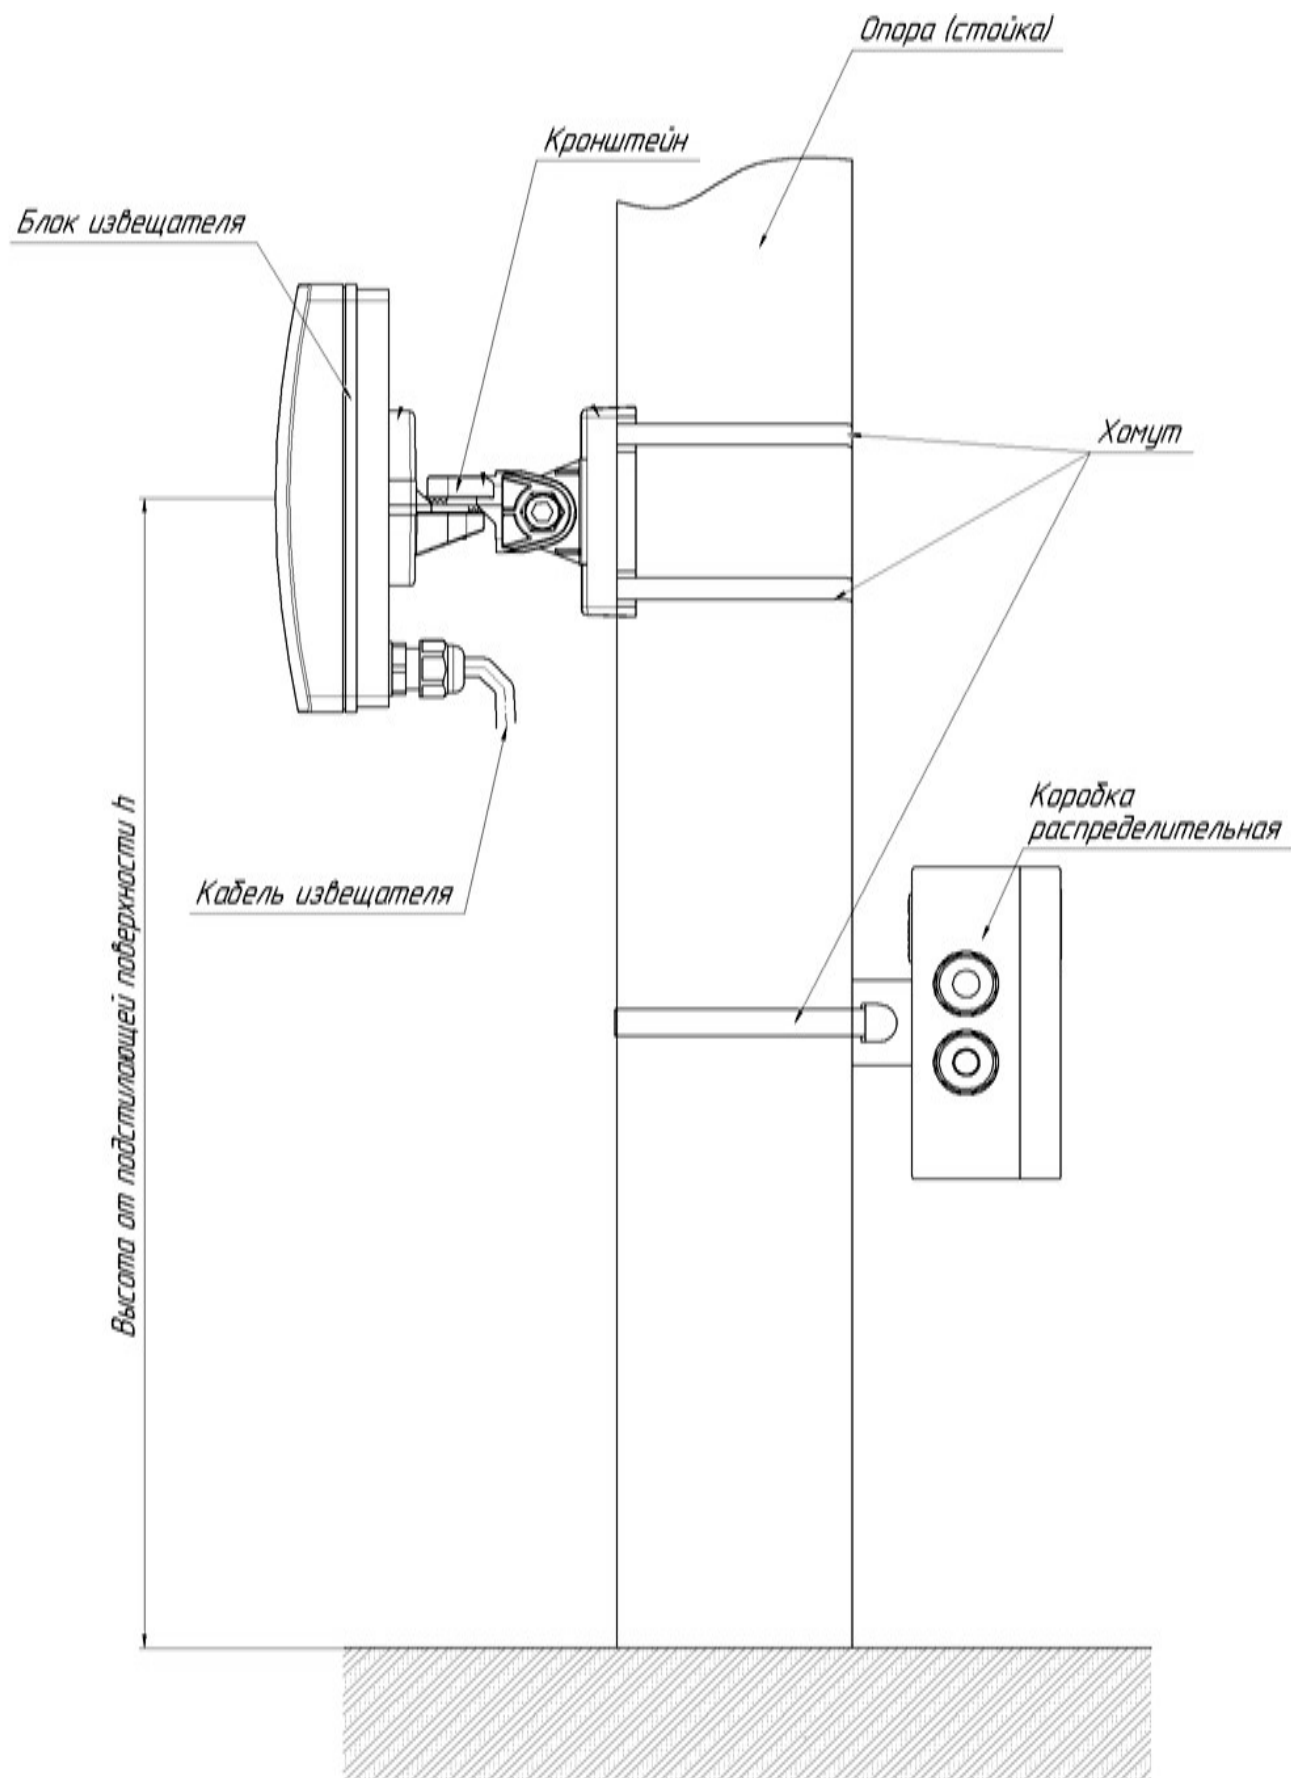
Установка блока извещателя и КР на опоре
